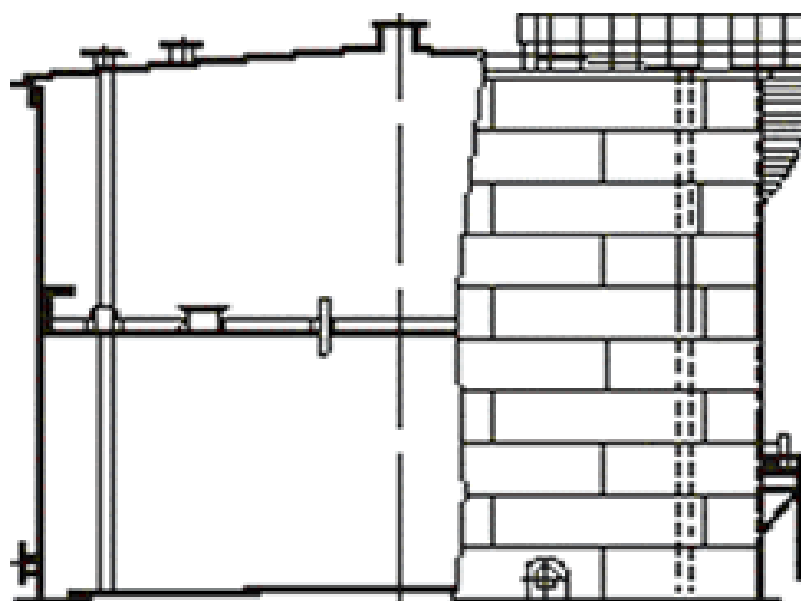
Цилиндрический сварной стальной резервуар с конической крышей и кольцевой лестницей
